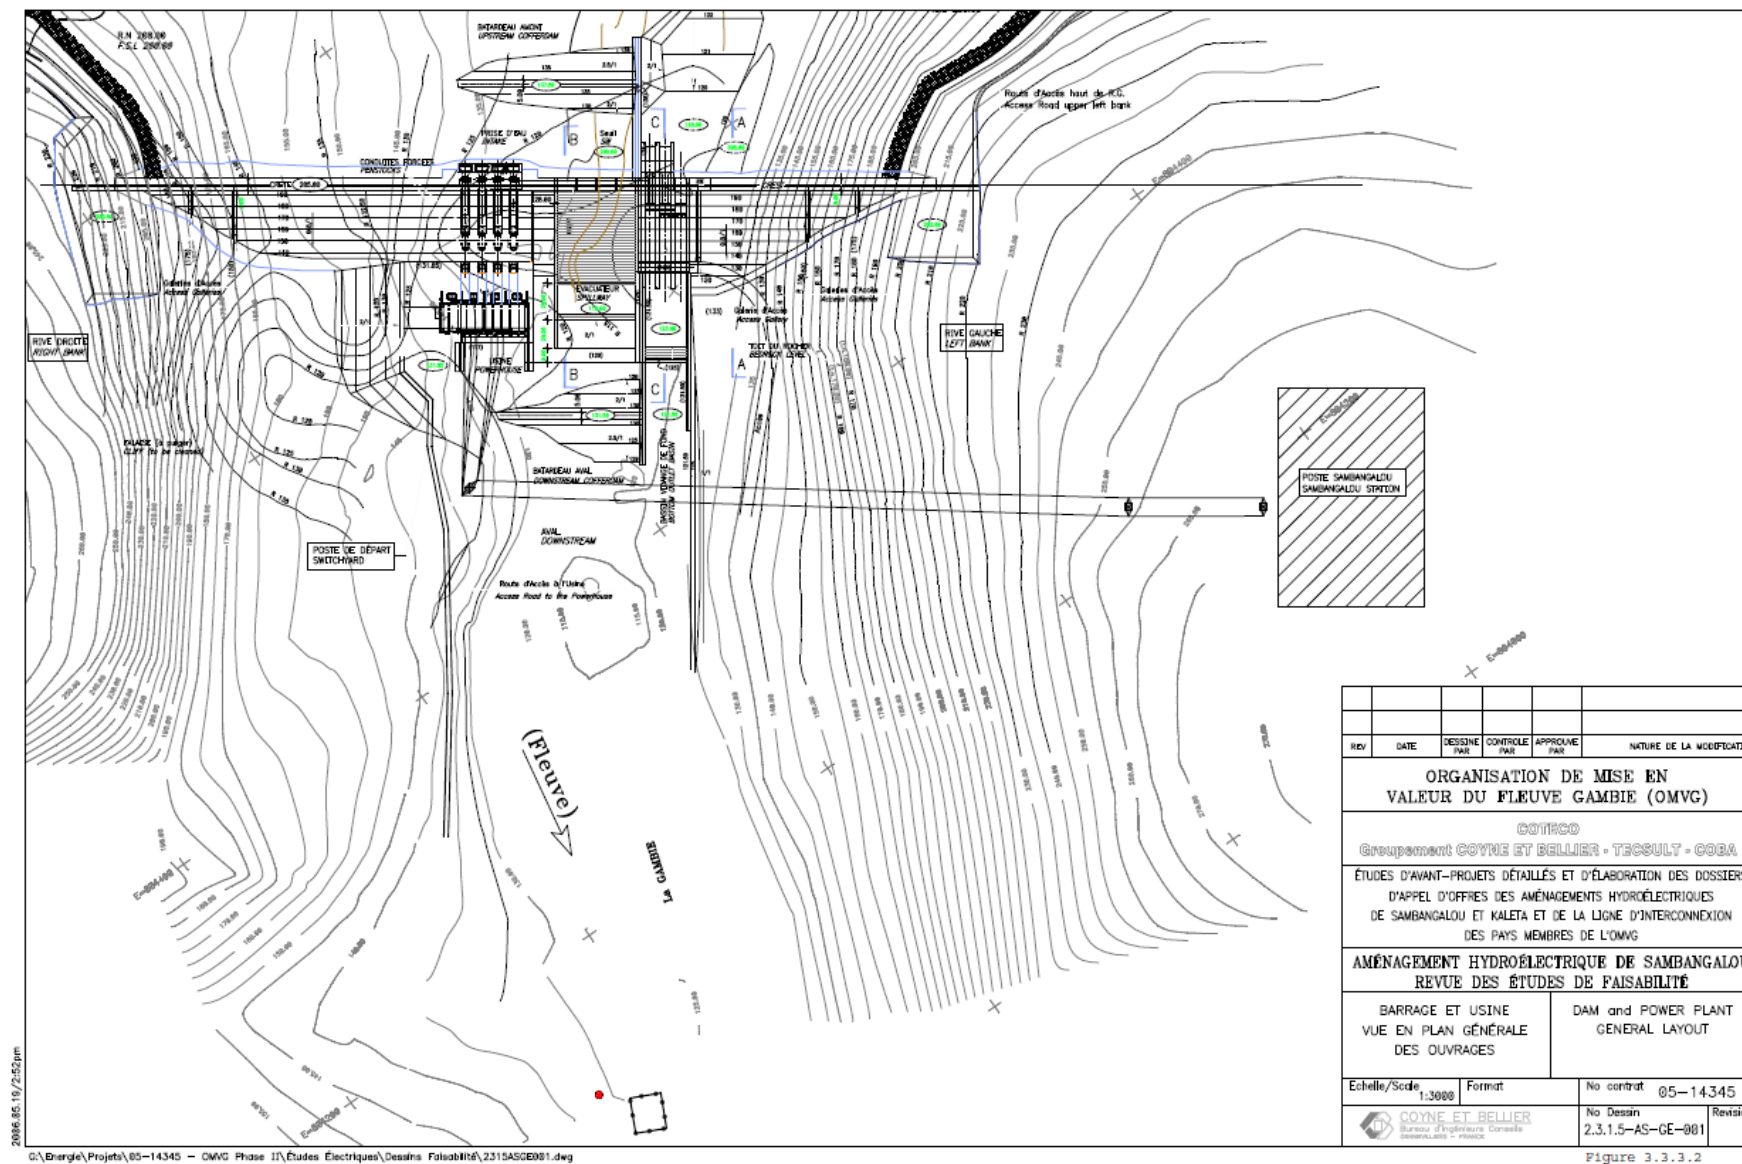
Vue en plan générale des ouvrages - Sambangalou
